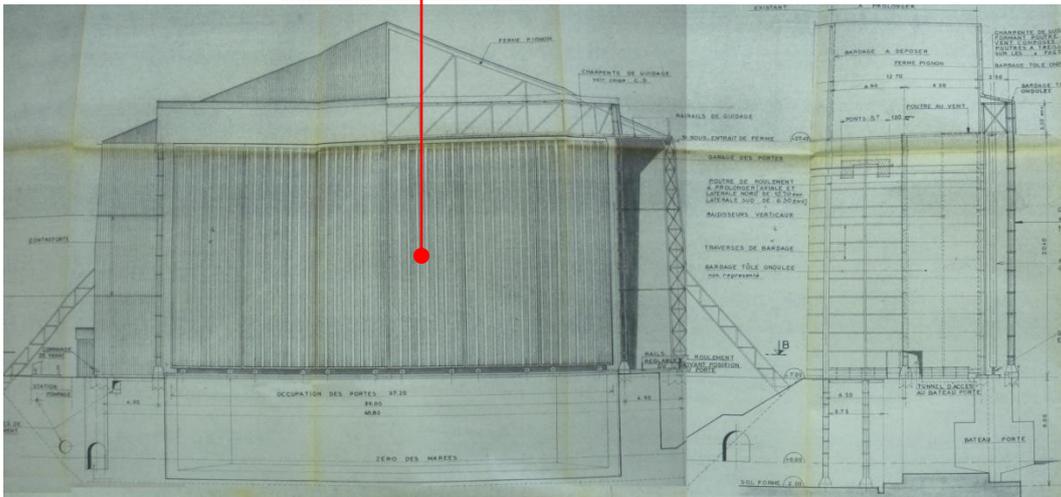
Fermeture du pignon ouest par une porte motorisée
